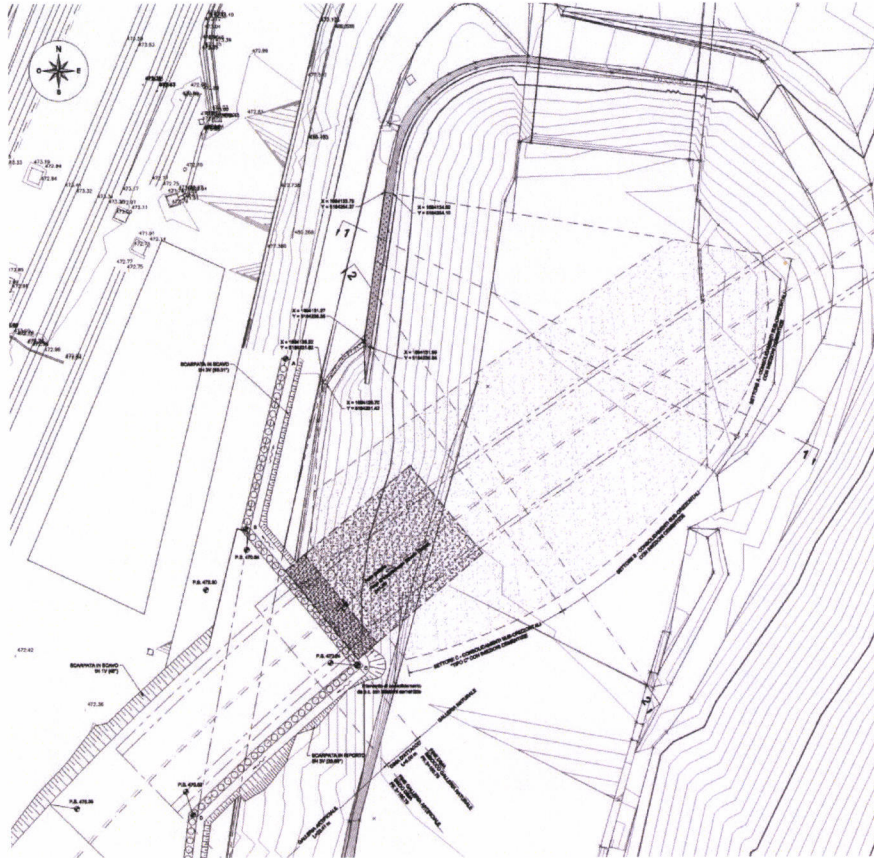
Planimetria degli interventi di consolidamento sotto il rilevato autostradale
